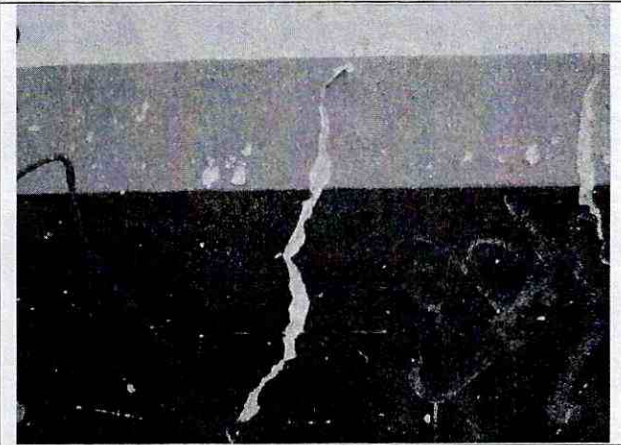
Fisuras y agrietamientos en el muro.
